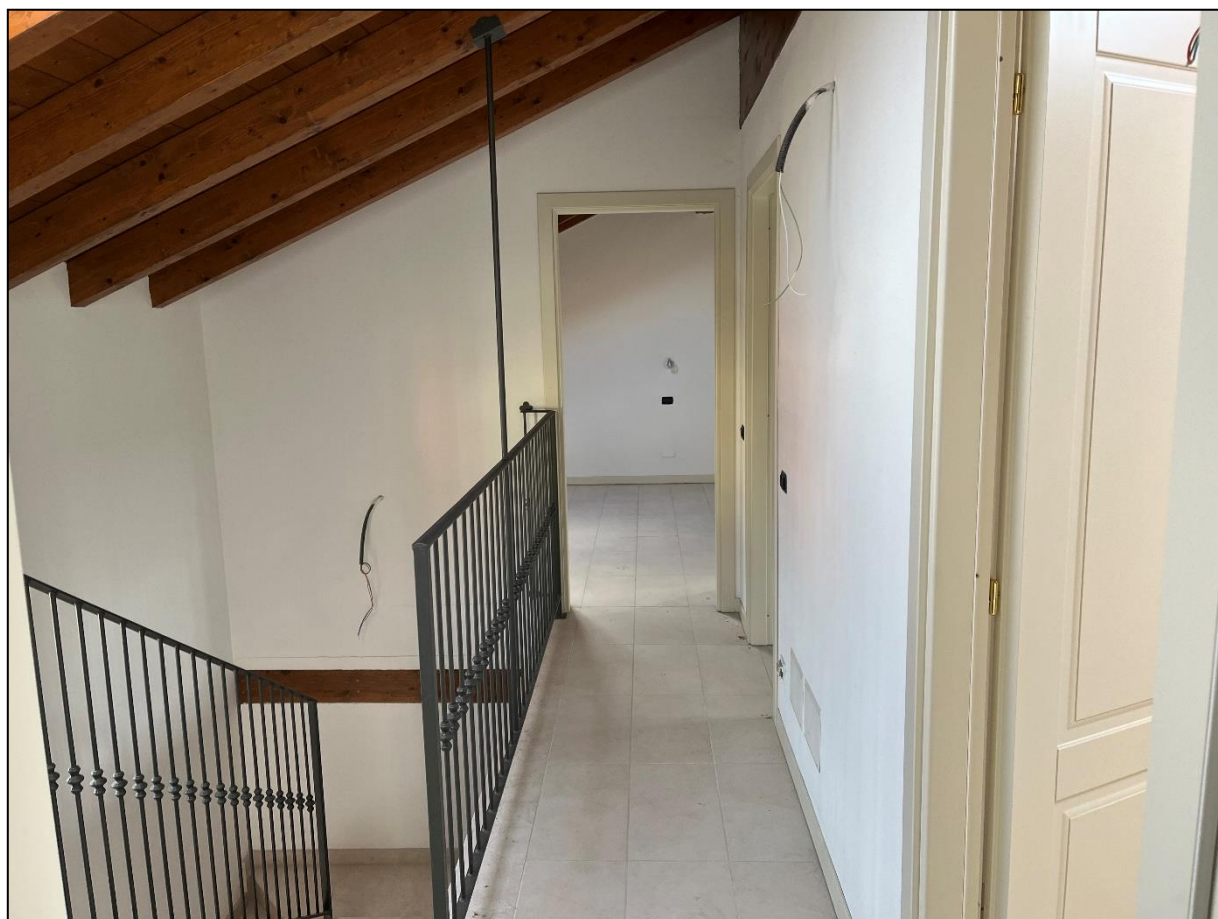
e 12 – Camera con bagno dedicato (P.sottotetto)
